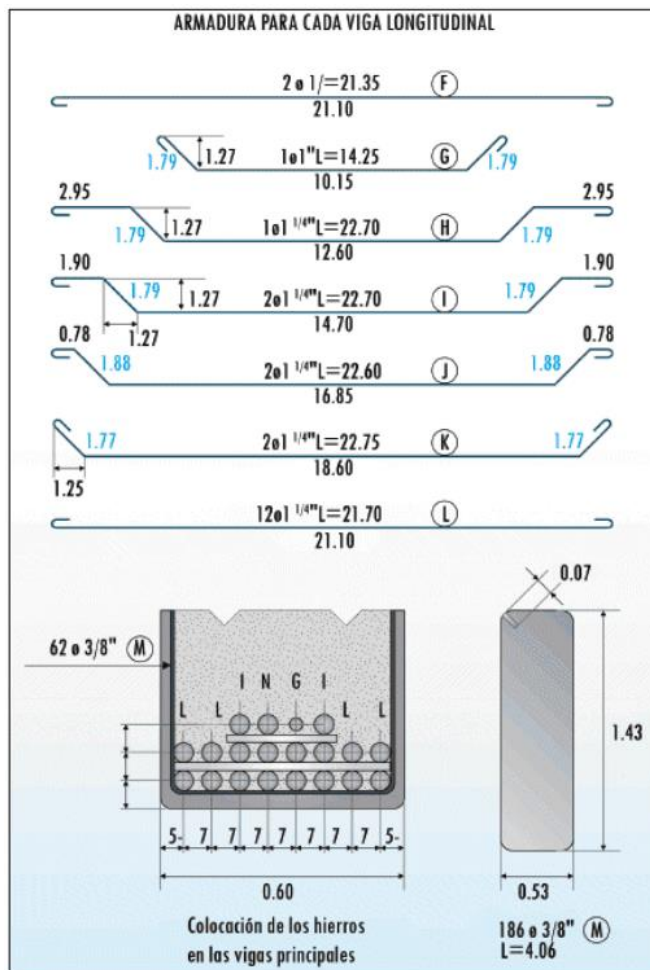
Esquemas de plano de puentes de viga y losa simplemente apoyado ($L=20$ m)
